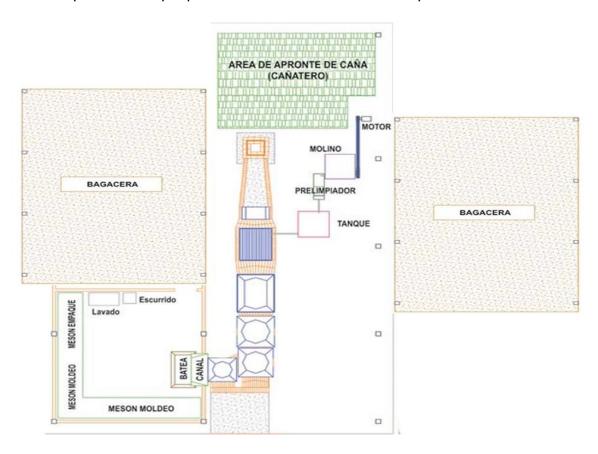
Distribución en planta de un trapiche panelero en la vereda Zancudo.
